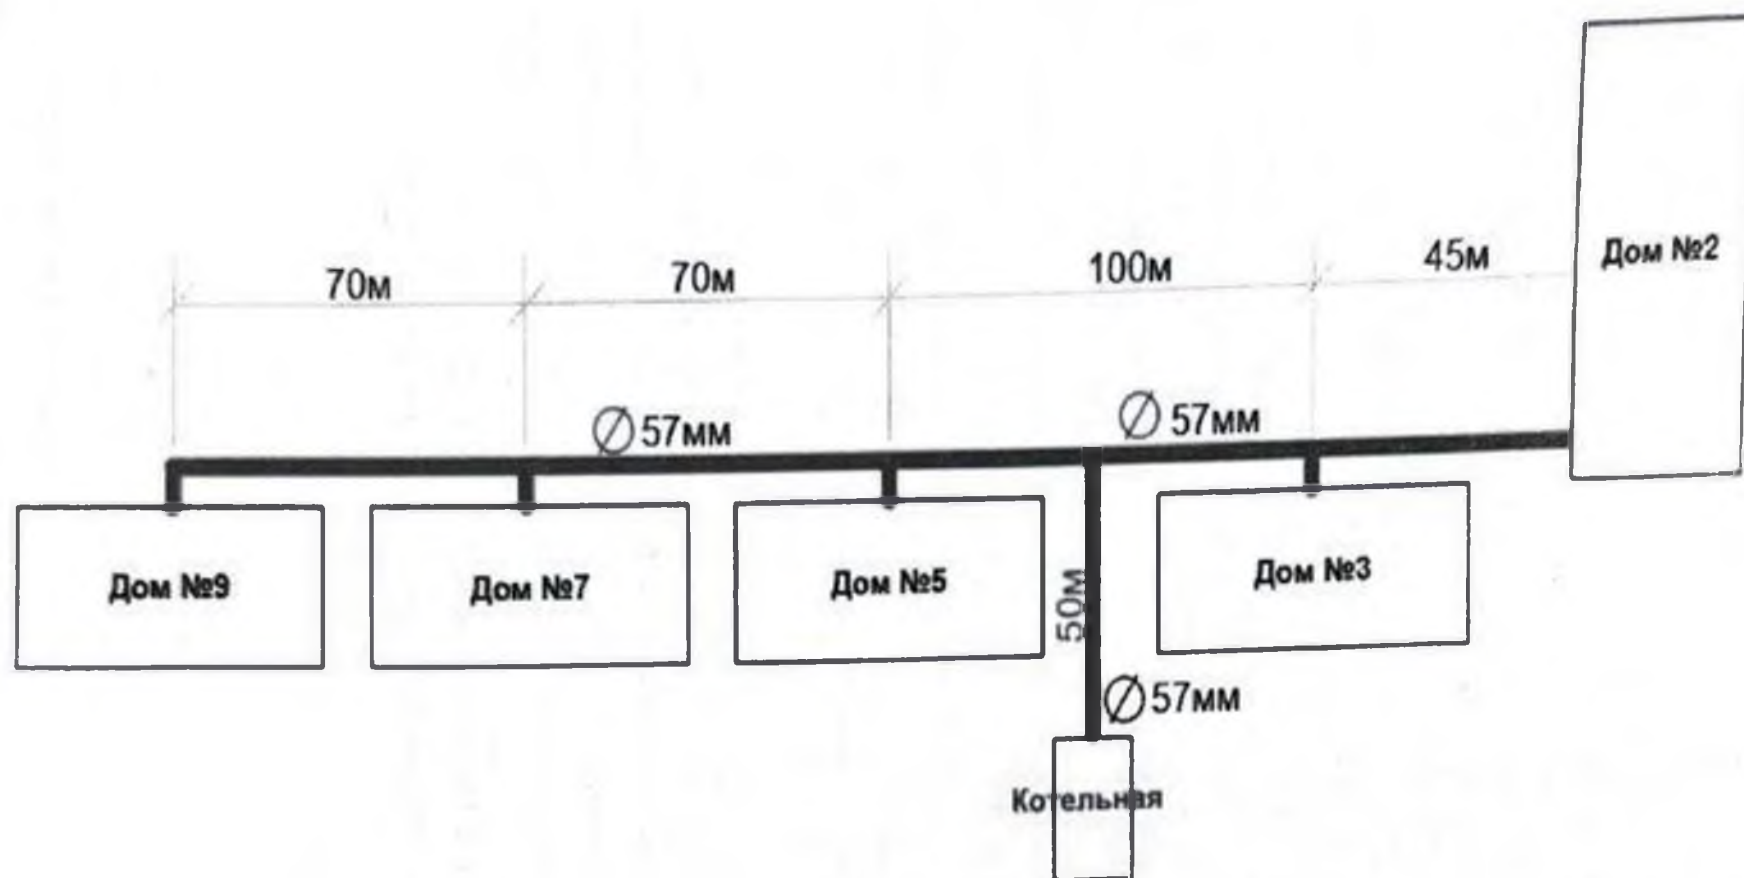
Схемы тепловых сетей котельной жилого фонда ст. Чагра
